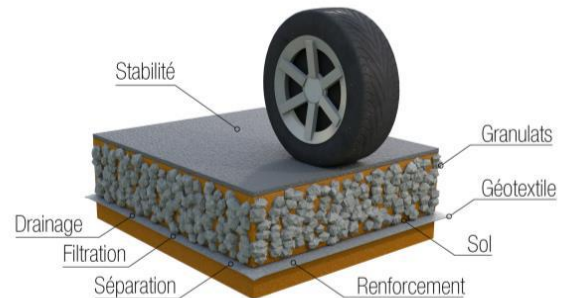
Coupe d'une structure de chaussée avec Texel Géo-9
